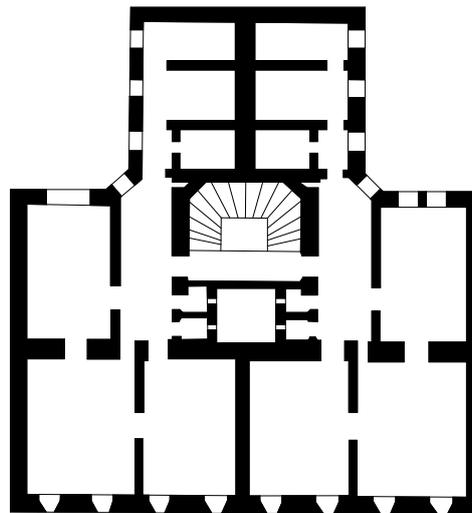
Grundriss, Bürgerliches Miethaus, Hochgründerzeit
